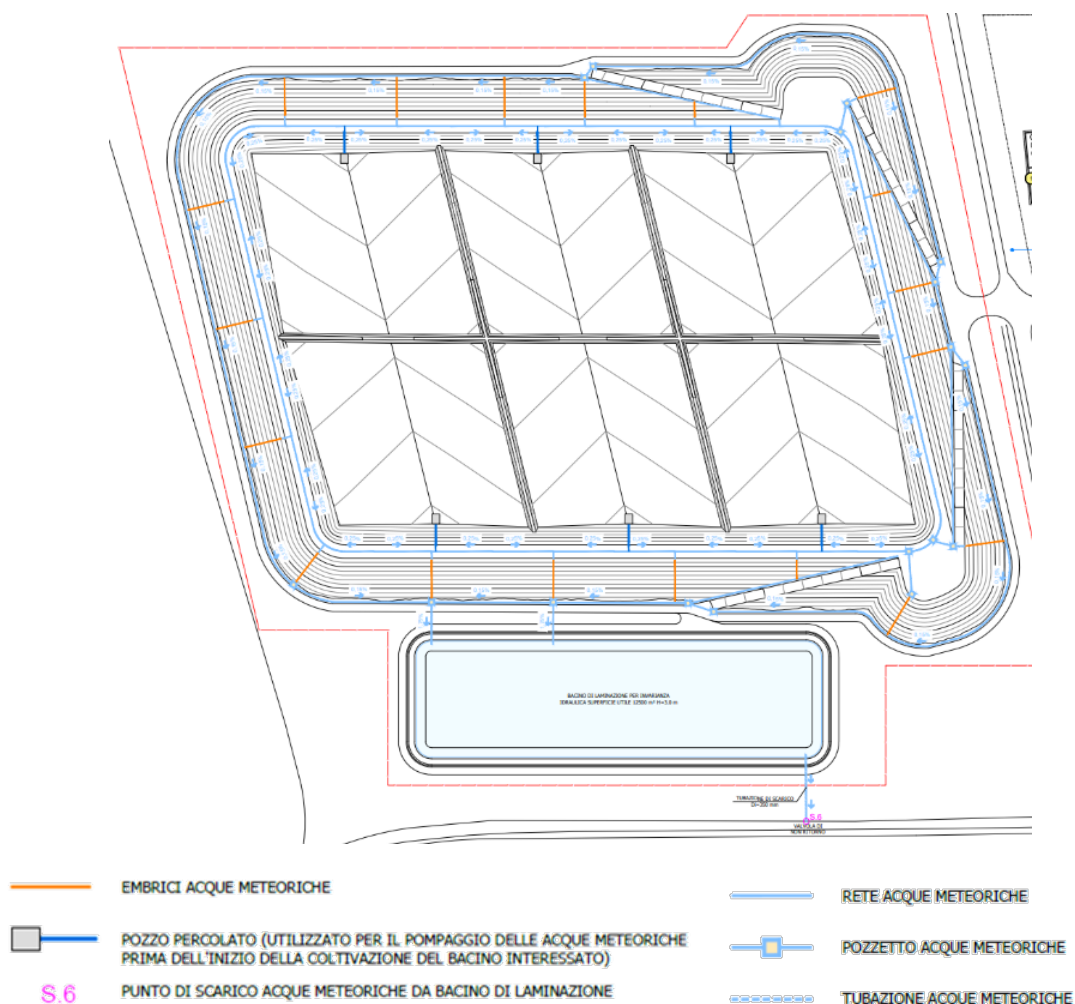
Planimetria rappresentante la gestione delle acque meteoriche - fase iniziale
